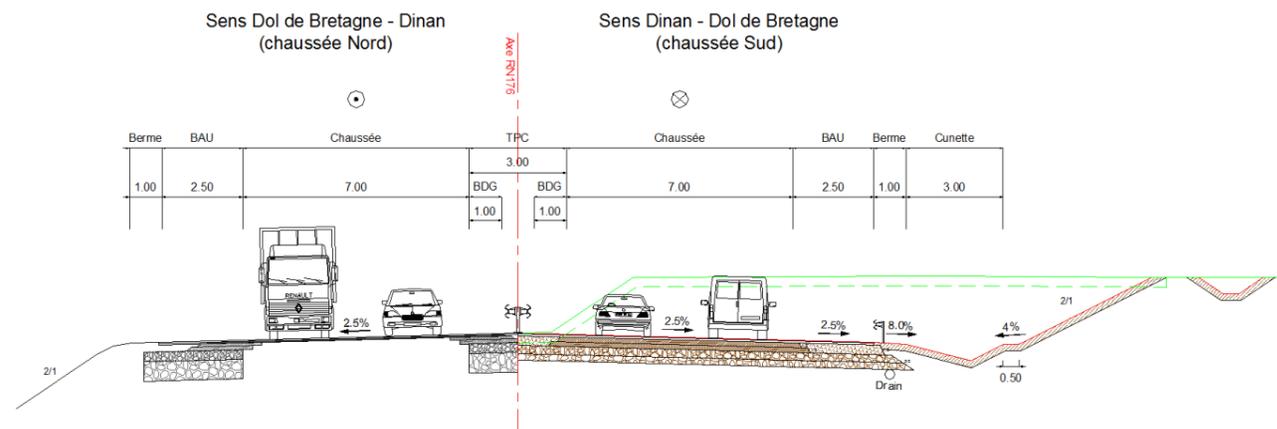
Profil en travers de la section courante en déblai (source ARCADIS)
